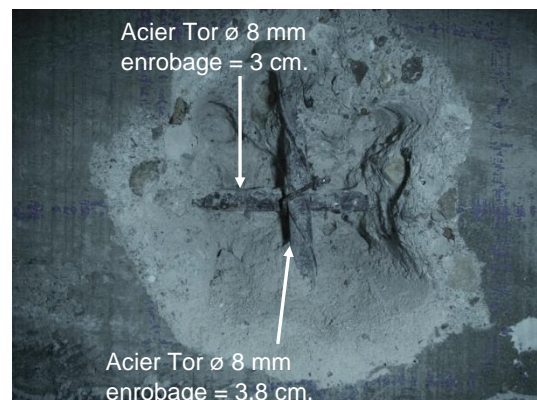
ouverture sur aciers au niveau de la retombée de la poutre
